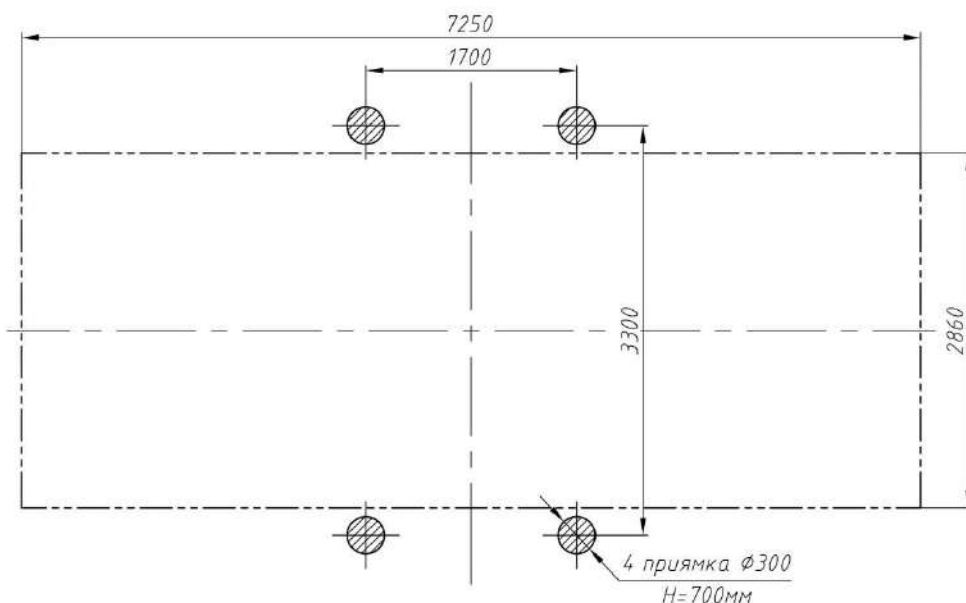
План фундамента Рамы для качелей двойной РТР 50-2
